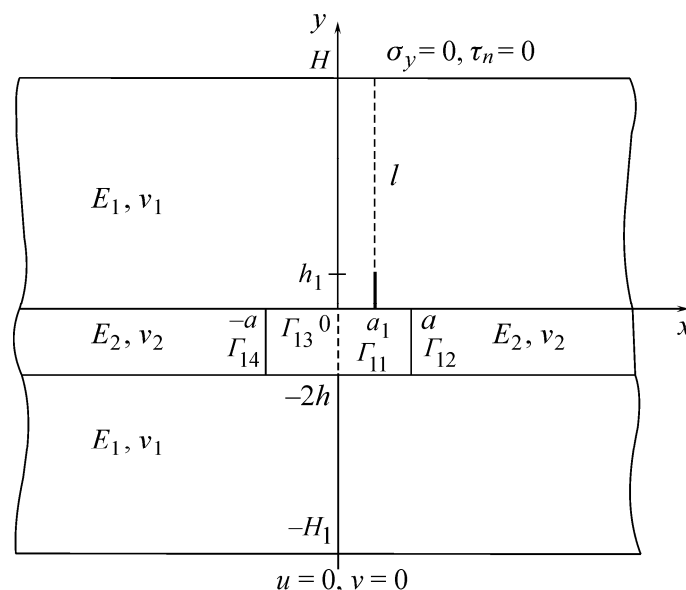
Расчетная схема выработки с трещиной в кровле
